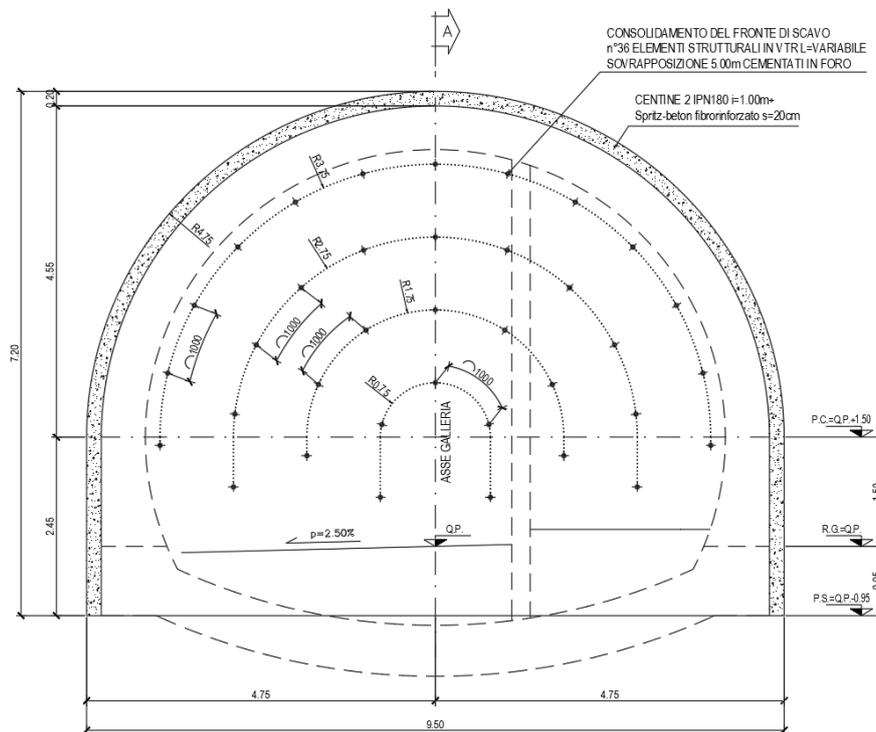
Sezione tipo Bypass pedocarrabile
